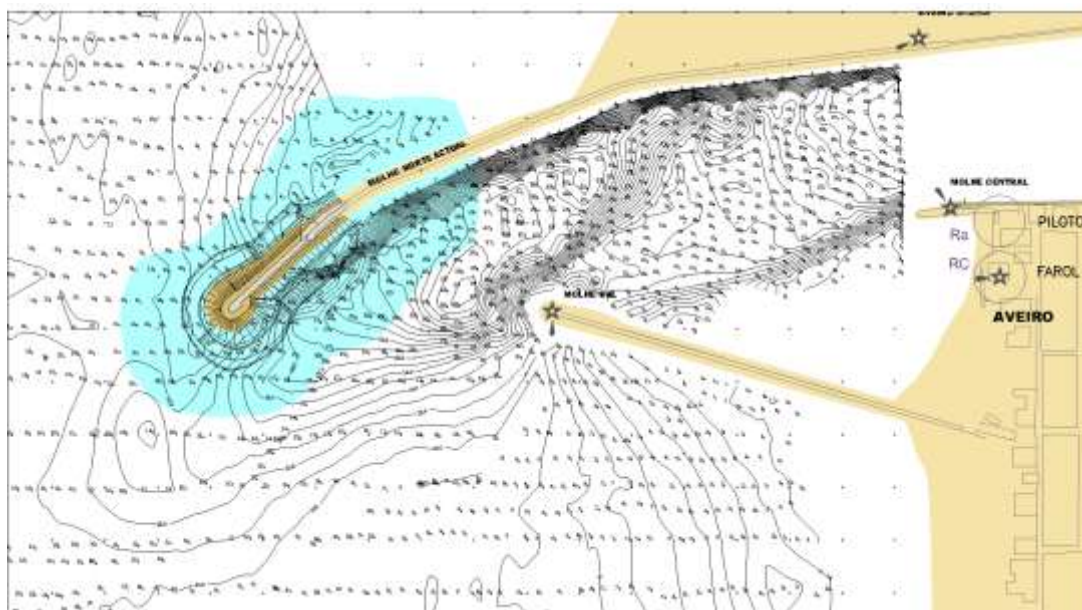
Planta geral do prolongamento do molhe Norte da Barra de Aveiro
